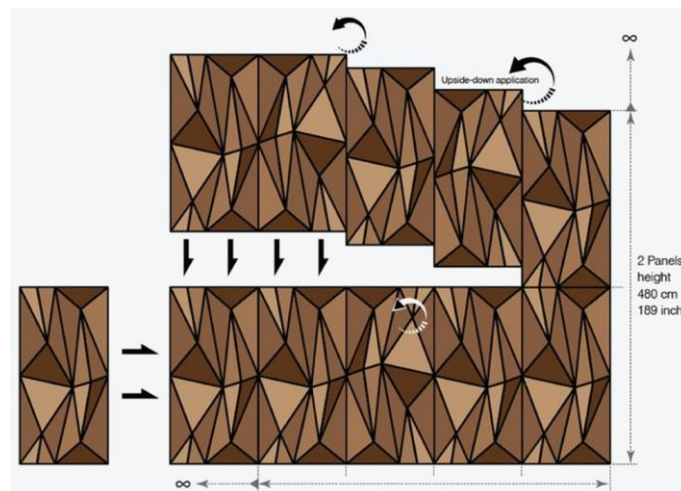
Instalación y combinación del Geta wall panel. Adaptado de: Mikodam.
